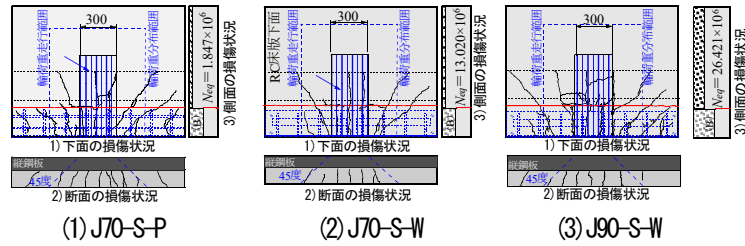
たわみ 4.0mm 時のひび割れ状況
